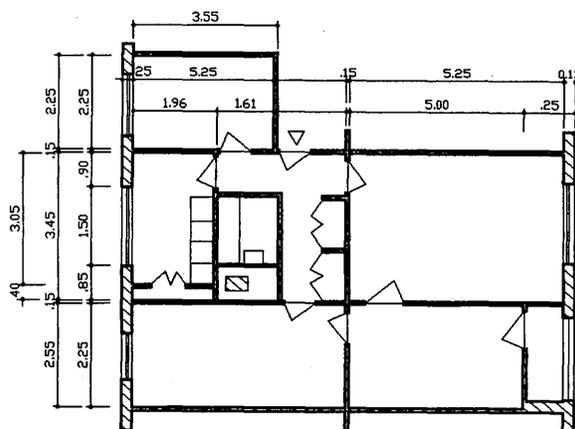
Planta de una vivienda en un edificio de varias plantas realizado con grandes paneles prefabricados, utilizada a modo de ejercicio comparativo del tamaño de los elementos.
